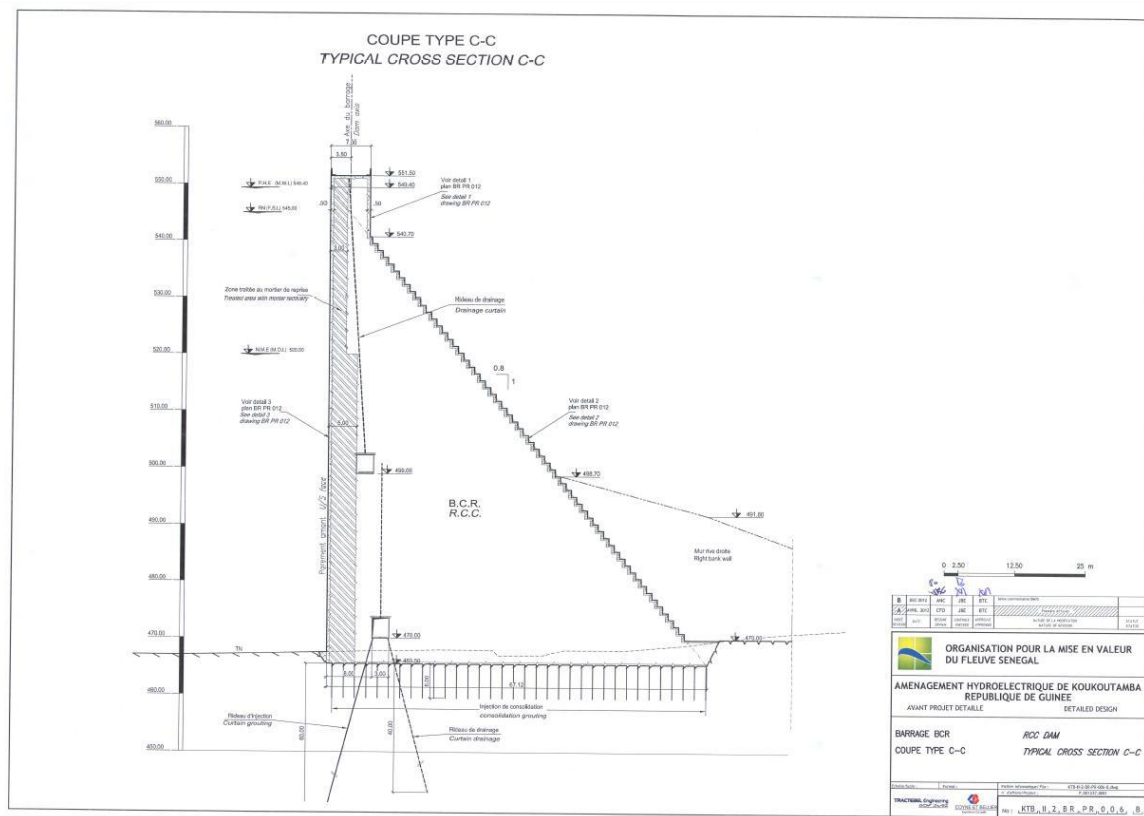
Coupe-type barrage BCR de Koukoutamba
